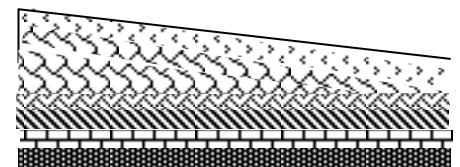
Coupe de plancher terrasse non accessible -corps creux-
